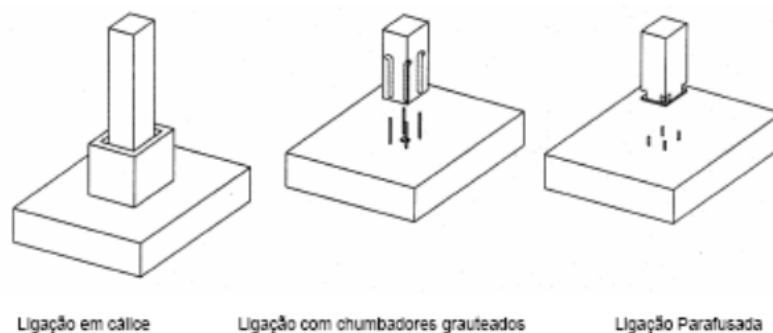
Tipos de ligações entre pilares e fundações (Fonte: Jeremias, 2007).
